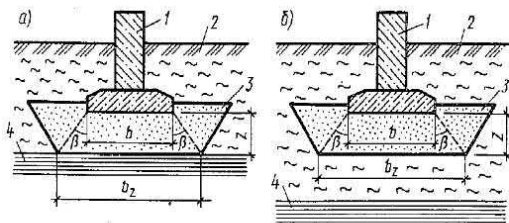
Устройство песчаных подушек при малой (а) и большой (б) толщине слабых грунтов:
